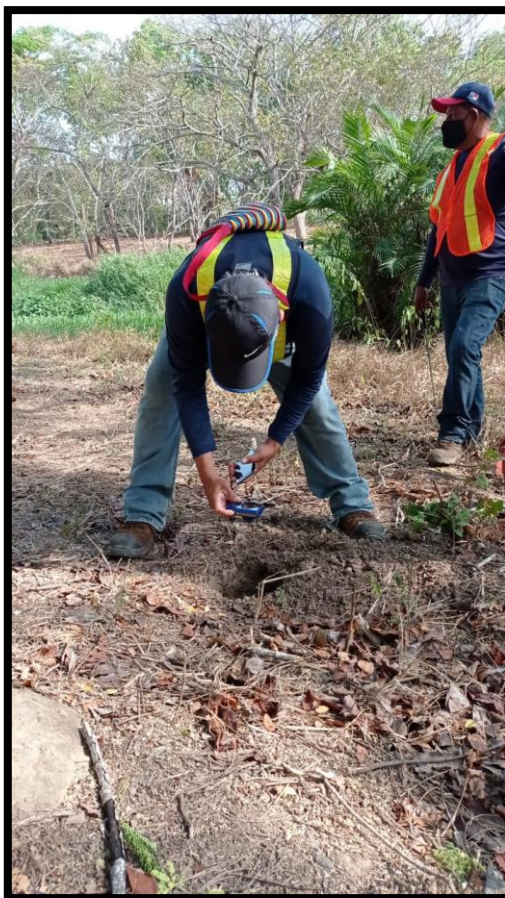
y N°3. Vistas del área donde será ejecutado el proyecto
